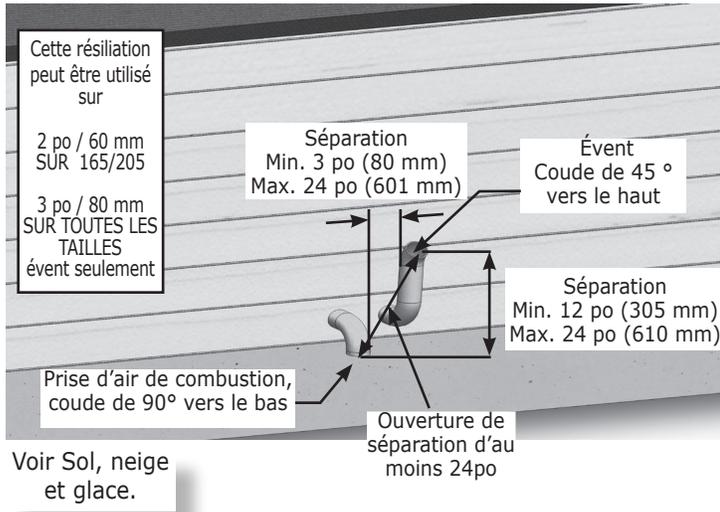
(3 po/80 mm seulement) Événement latéral de tuyau double
